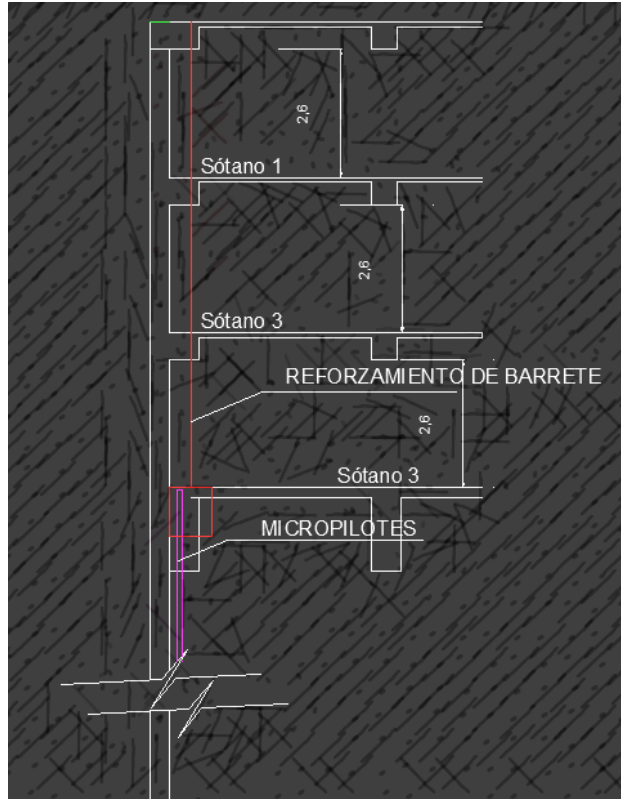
Corte de micro-pilotes y reforzamiento de barrete. Fuente propia
